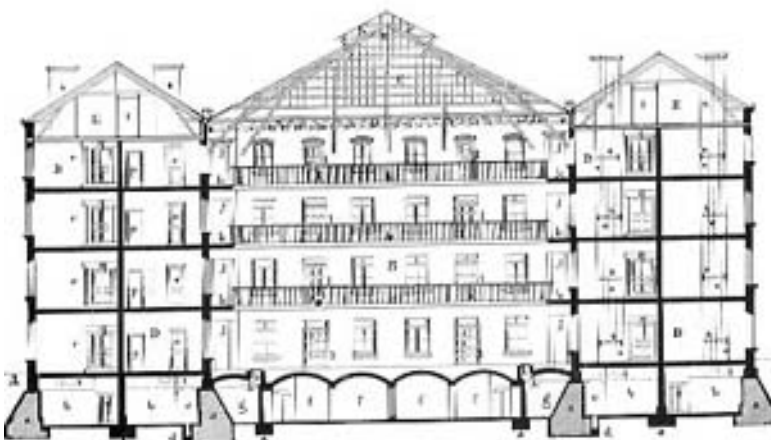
pianta e sezione del corpo residenziale del Familisterio di Guisa.
